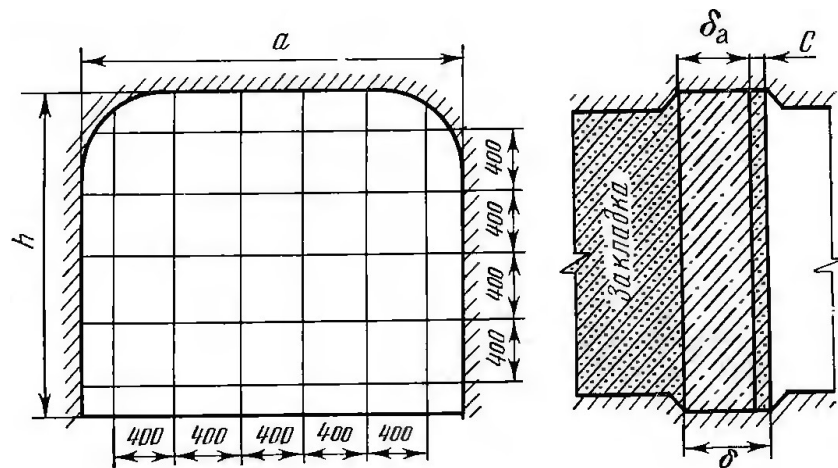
Конструкция железобетонной перемычки, свободно опертой по контуру [5]
